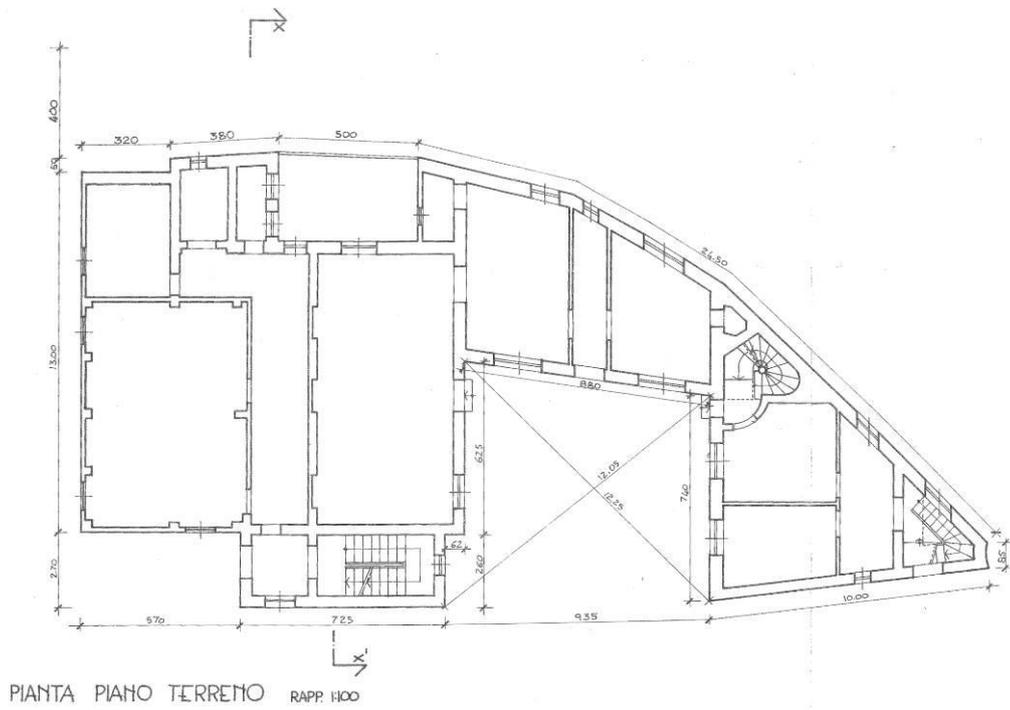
Planimetria Palazzina "M" - Pian terreno
